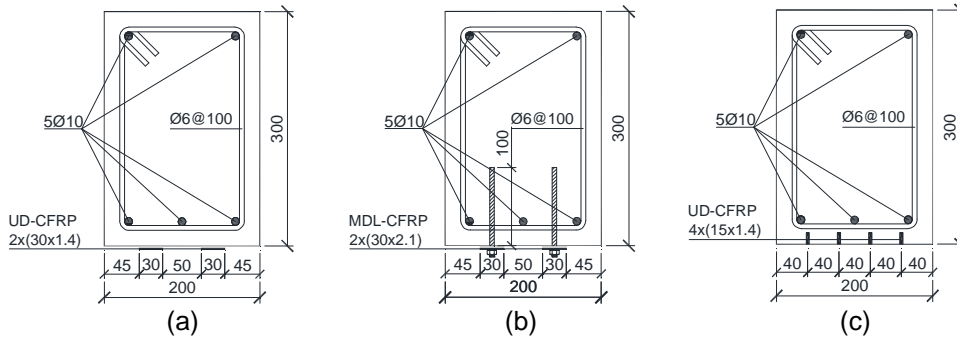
Secção transversal das vigas reforçadas: (a) EBR; (b) MF-EBR; (c) NSM. Nota: todas as dimensões estão em milímetros.
